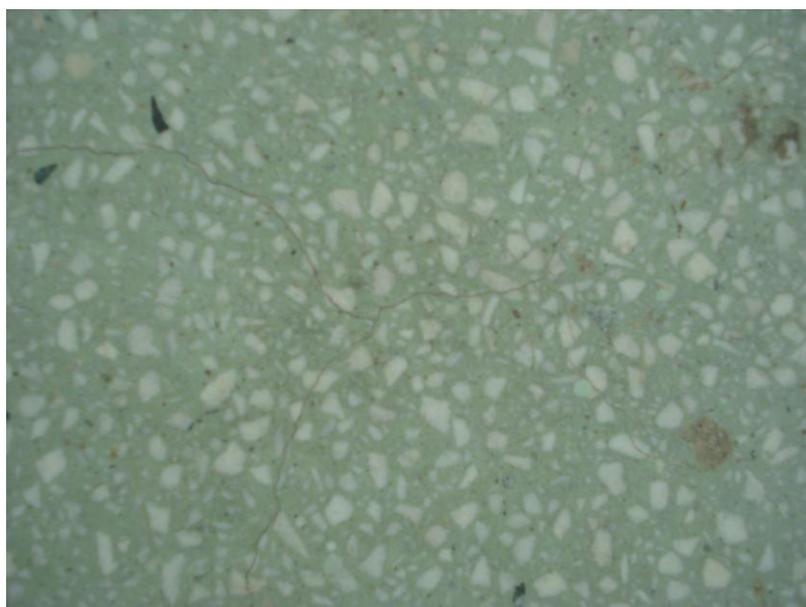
Piso marmorite: fissuras de retração em área de circulação externa. Foto da autora
